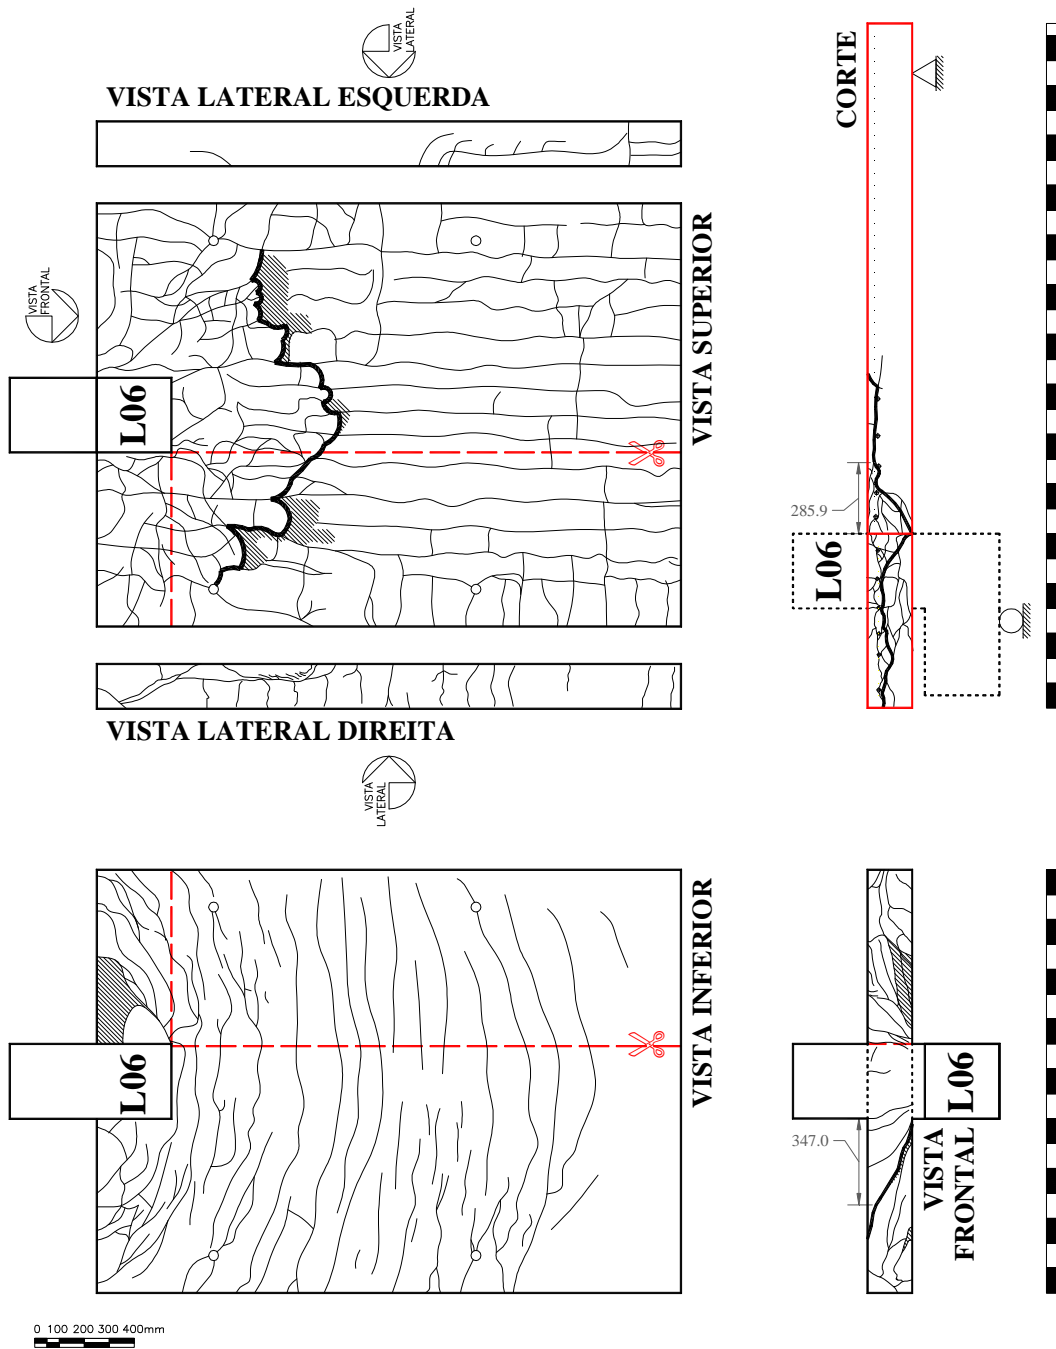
Padrão de fissuração da laje L06
